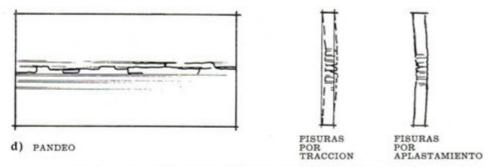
FISURAS EN LOS MUROS DE OBRA DE FABRICA
